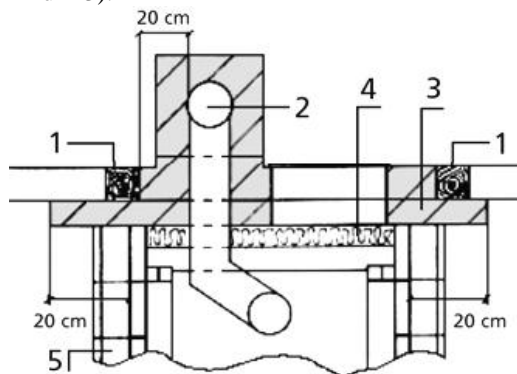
Ummauerung von Bauteilen, Variante 2
